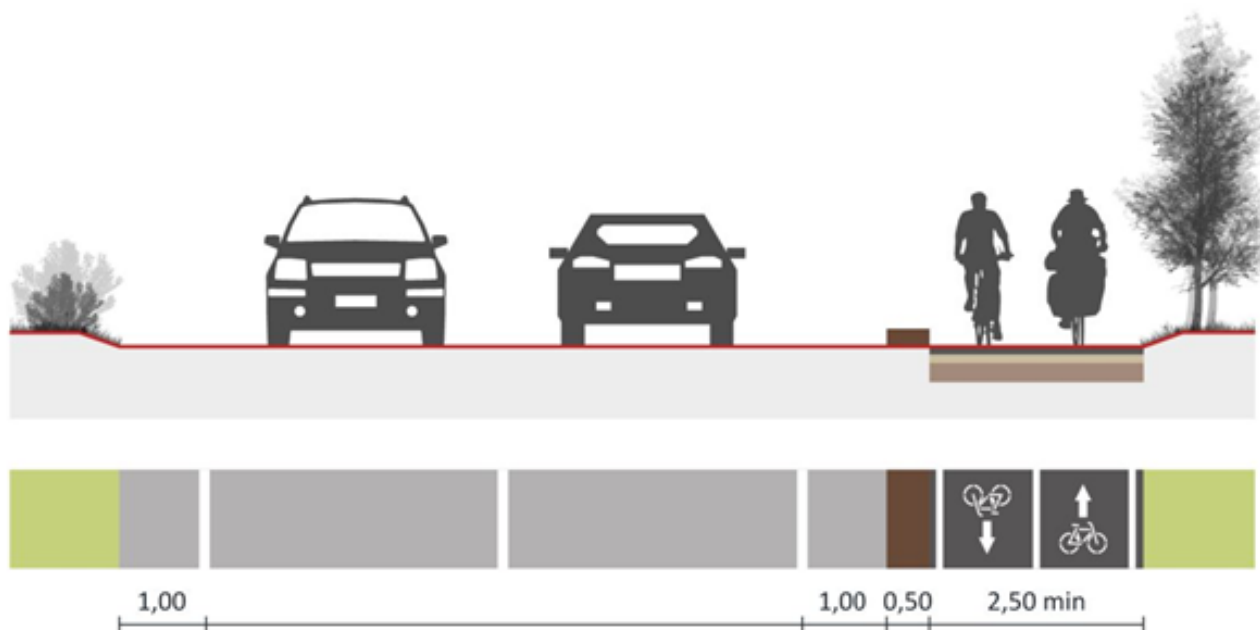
Sezione tipologica Pista ciclabile in sede riservata e protetta su strade extraurbane
